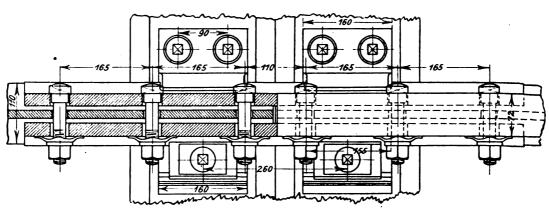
Längenschnitt und Grundrifs Oberbau 15c.
